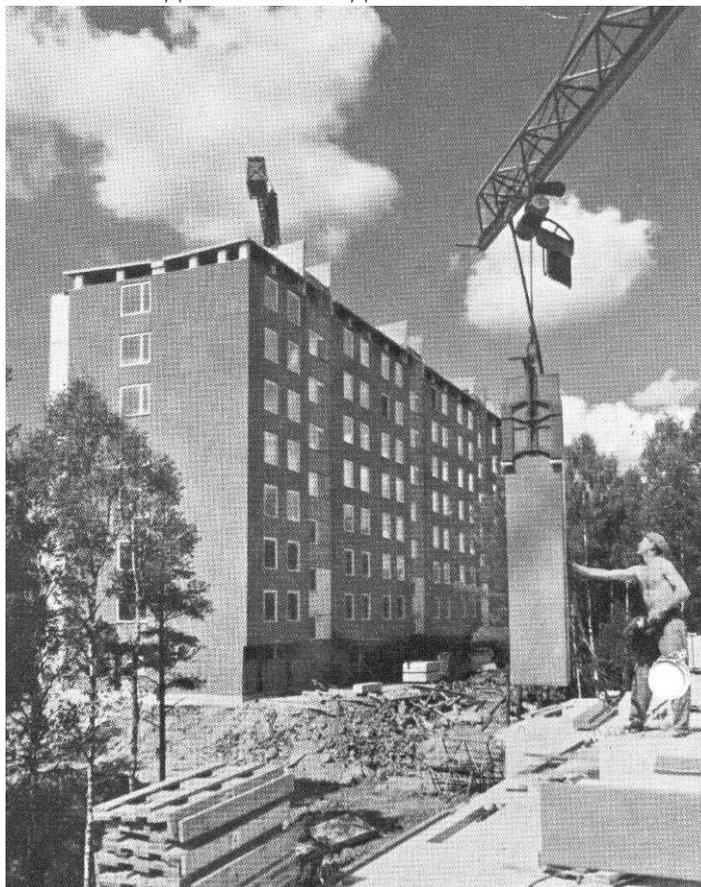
Сельское газобетонное строительство в Беларуси
